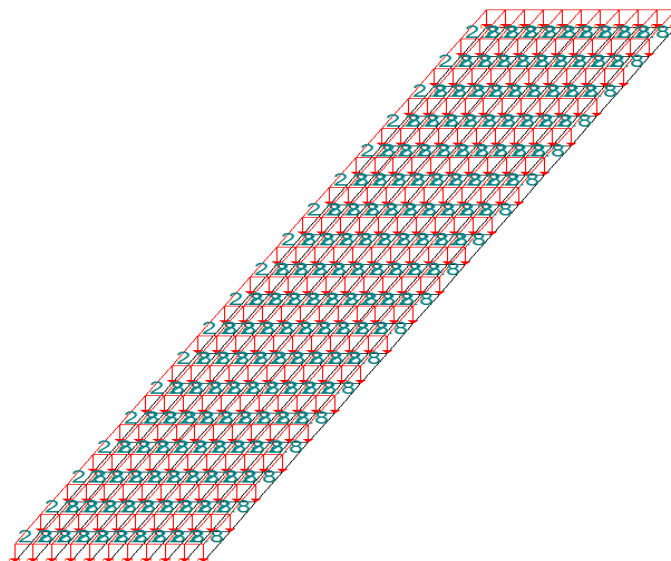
Загружение схемы нагрузкой от полезной нагрузки
